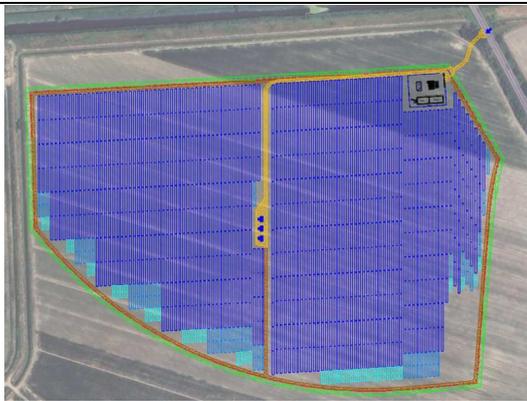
Sovrapposizione su ortofoto dell'area di impianto (in rosso) e del tracciato del cavidotto di connessione alla rete (in blu) - Fonte: Google Earth
